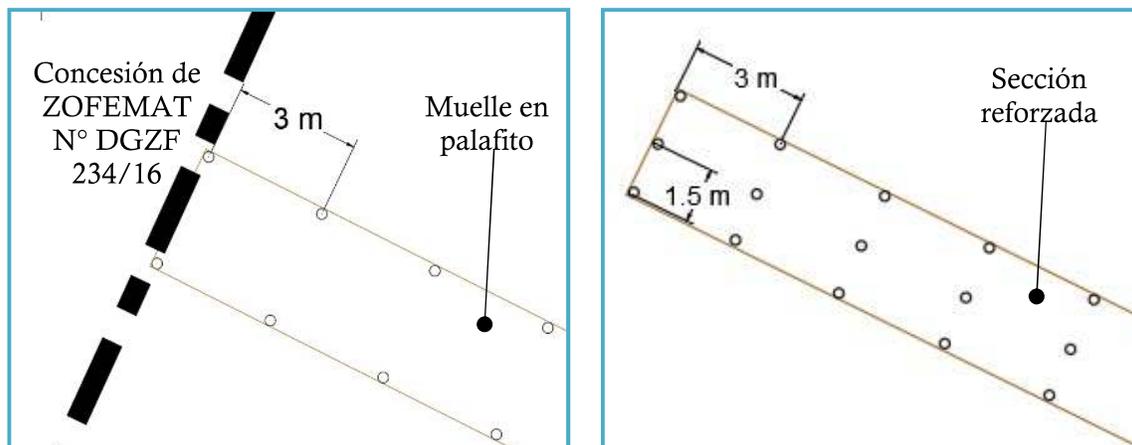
Separación entre postes del muelle a) Sección en palafito y B) refuerzo parte en “T”.
